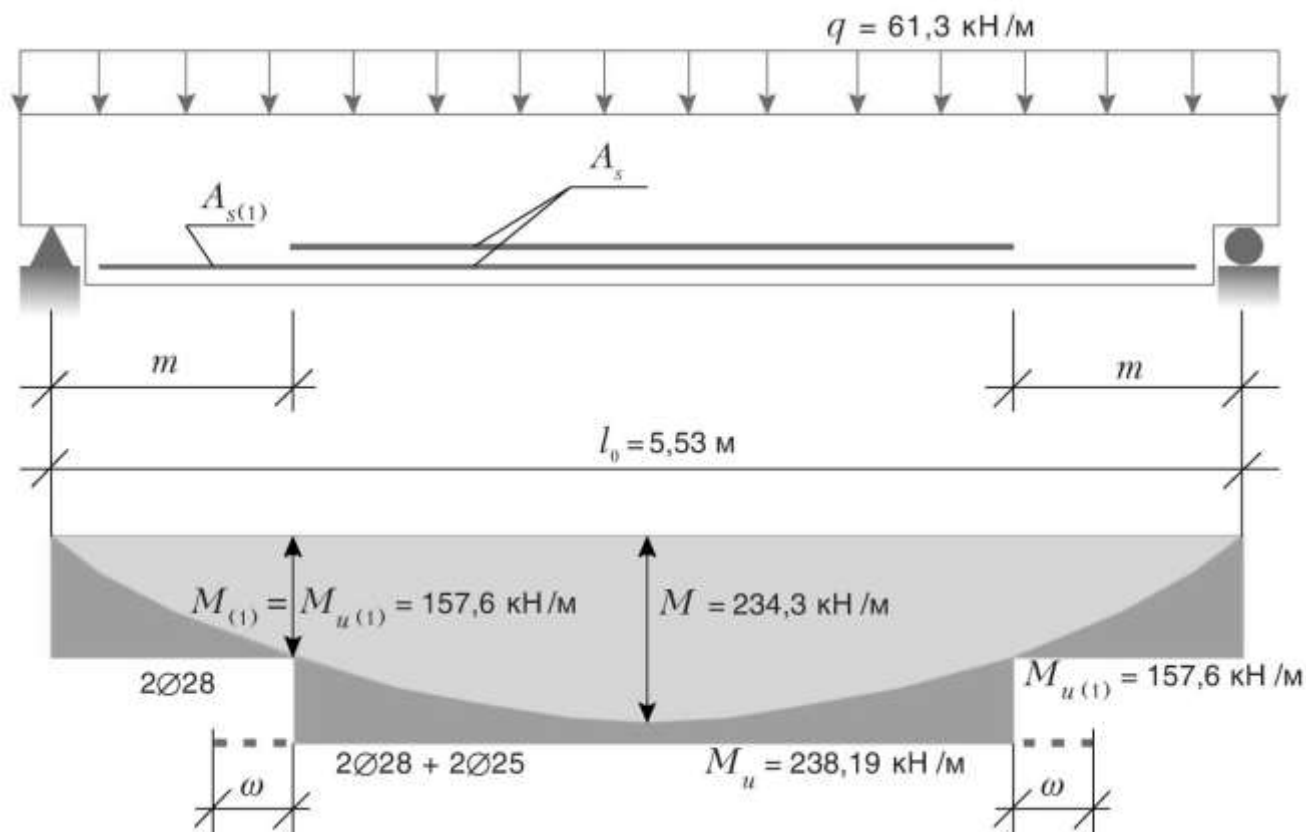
Схема армирования нижнего пояса ригеля. Эпюра материалов
